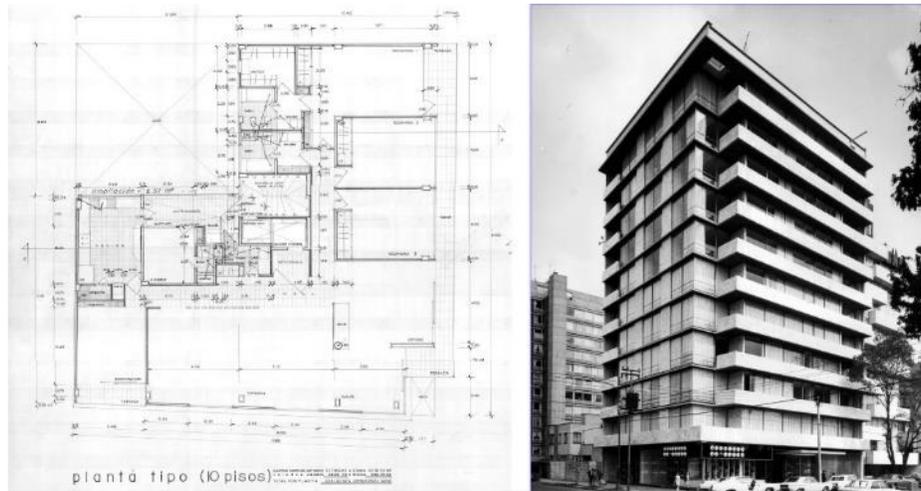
Plano planta tipo, febrero 1968, y vista de la fachada del edificio ubicado en Lope de Vega núm. 304, ca.1970
